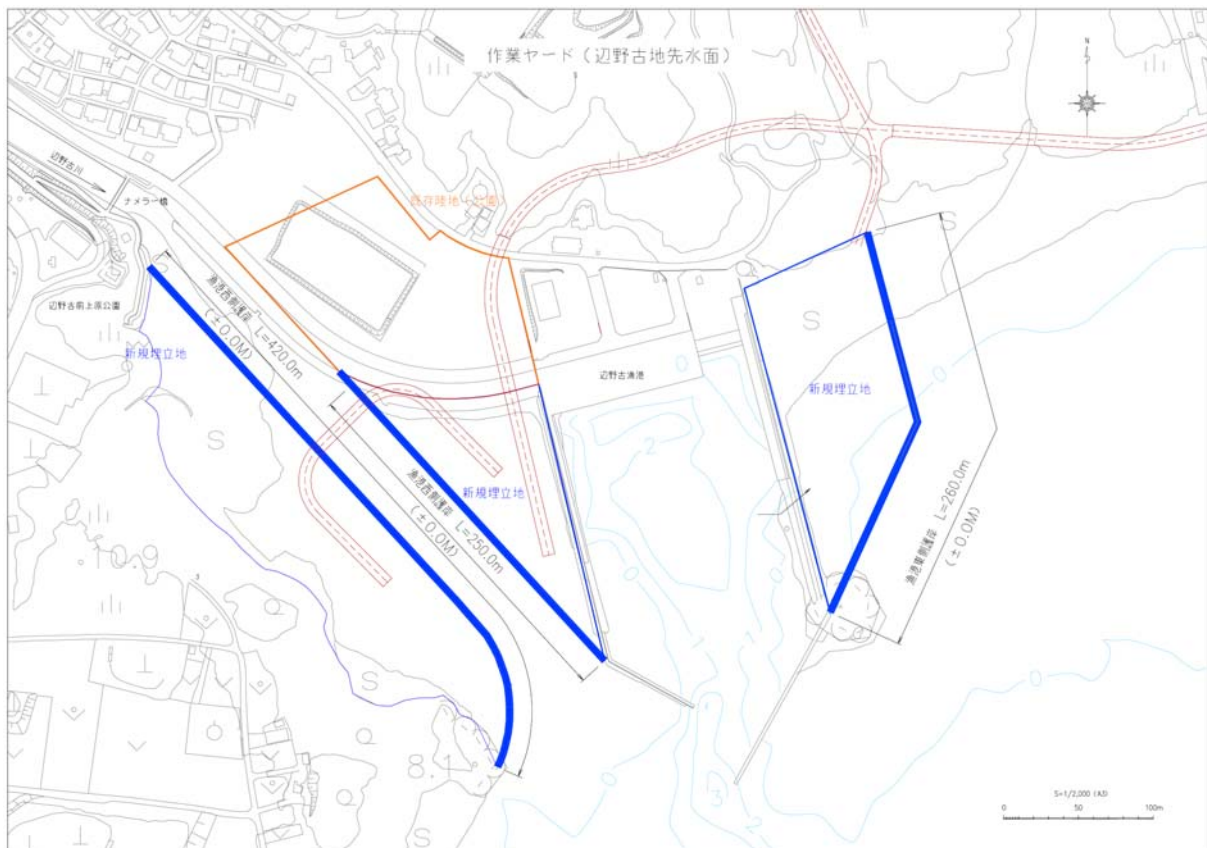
作業ヤード(辺野古地先水面)平面図
